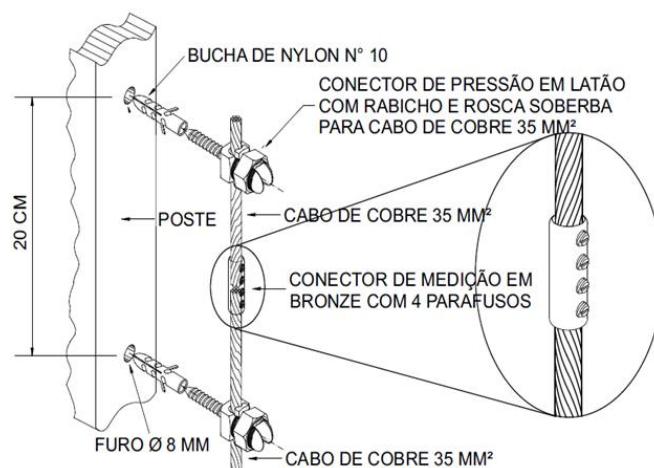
Detalhe da instalação da conexão de ensaio para condutores de descida no poste de concreto.
